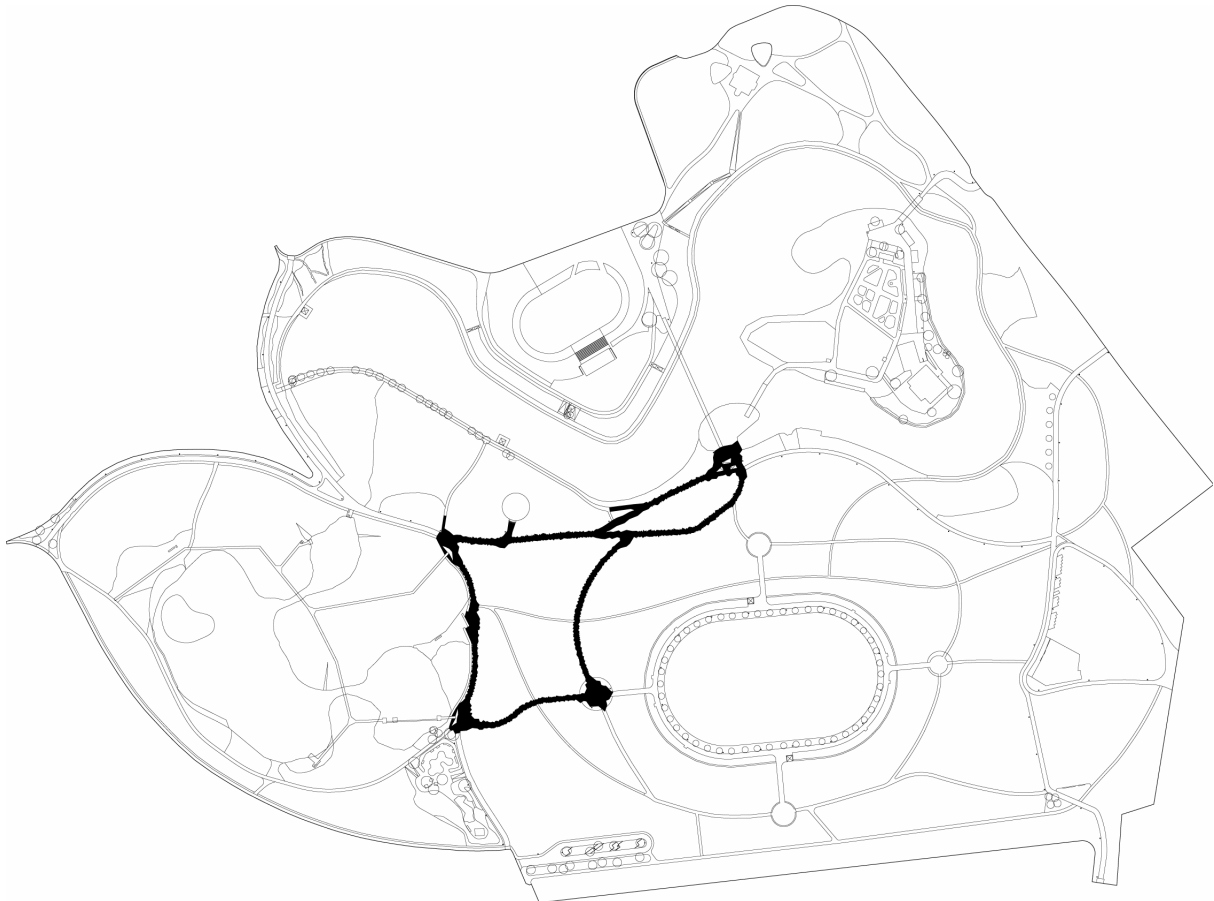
overzichtsplan Maria Hendrikapark met aanduiding Aleph
